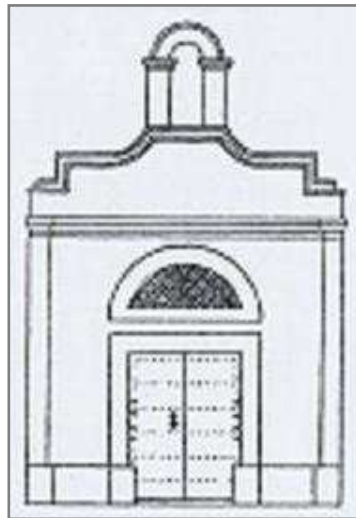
Alzado de la fachada principal de la Capilla de Santa Bárbara. L' Eco de Sitges 1921.
